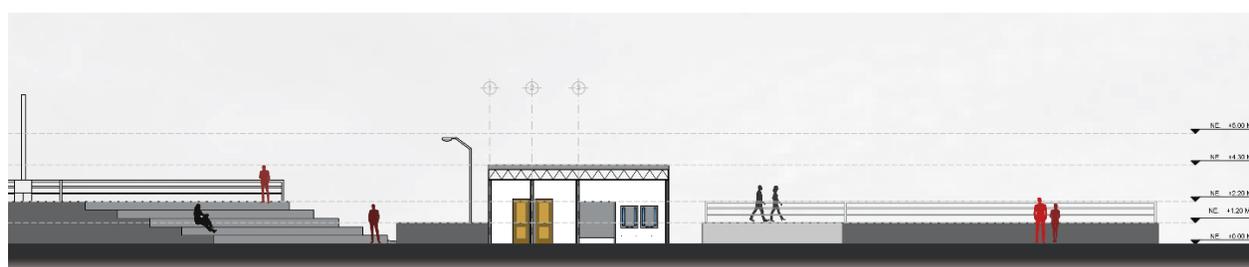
Sección Corte - perfil J-J'; Fuente: Elaboración propia
